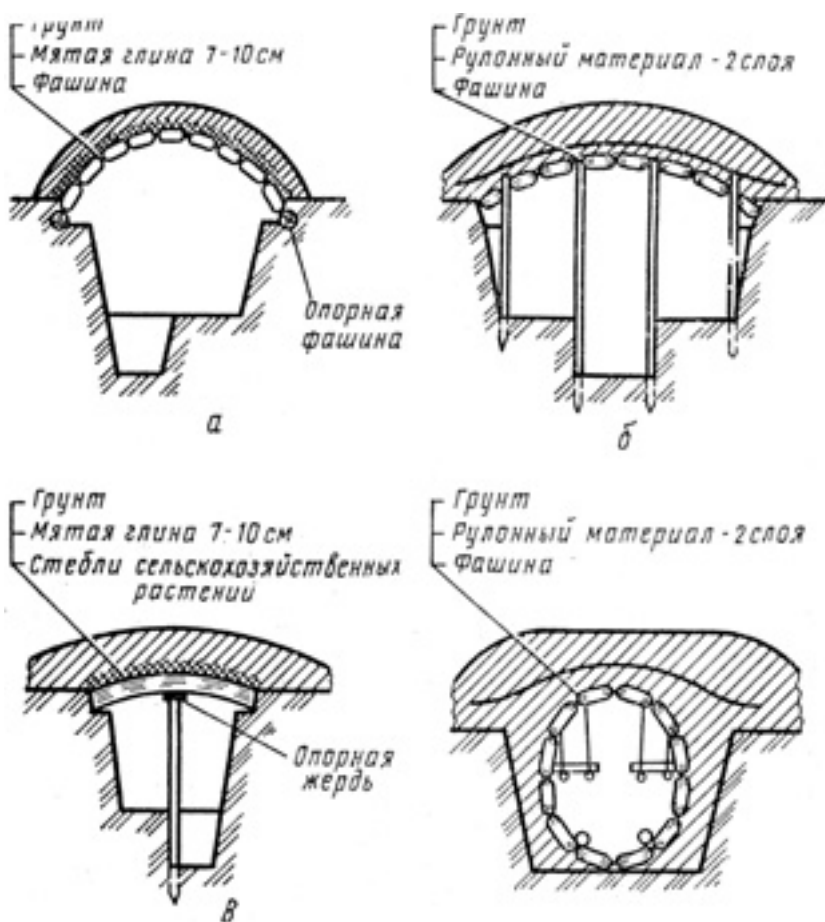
Поперечные сечения БВПРУ на 8–10 чел. Из различных местных материалов: а – из хворостяных фашин без одежды крутостей; б – из фашин с одеждой крутостей; в – из стеблей сельскохозяйственных растений без одежды крутостей; г – из кольцевых фашин
